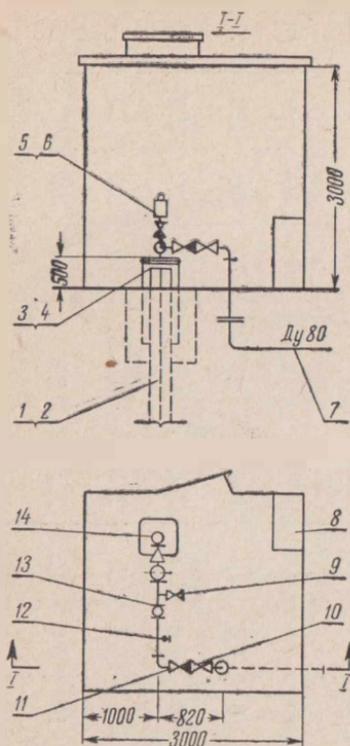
Схема наземной насосной станции на трубопроводе колодца:
